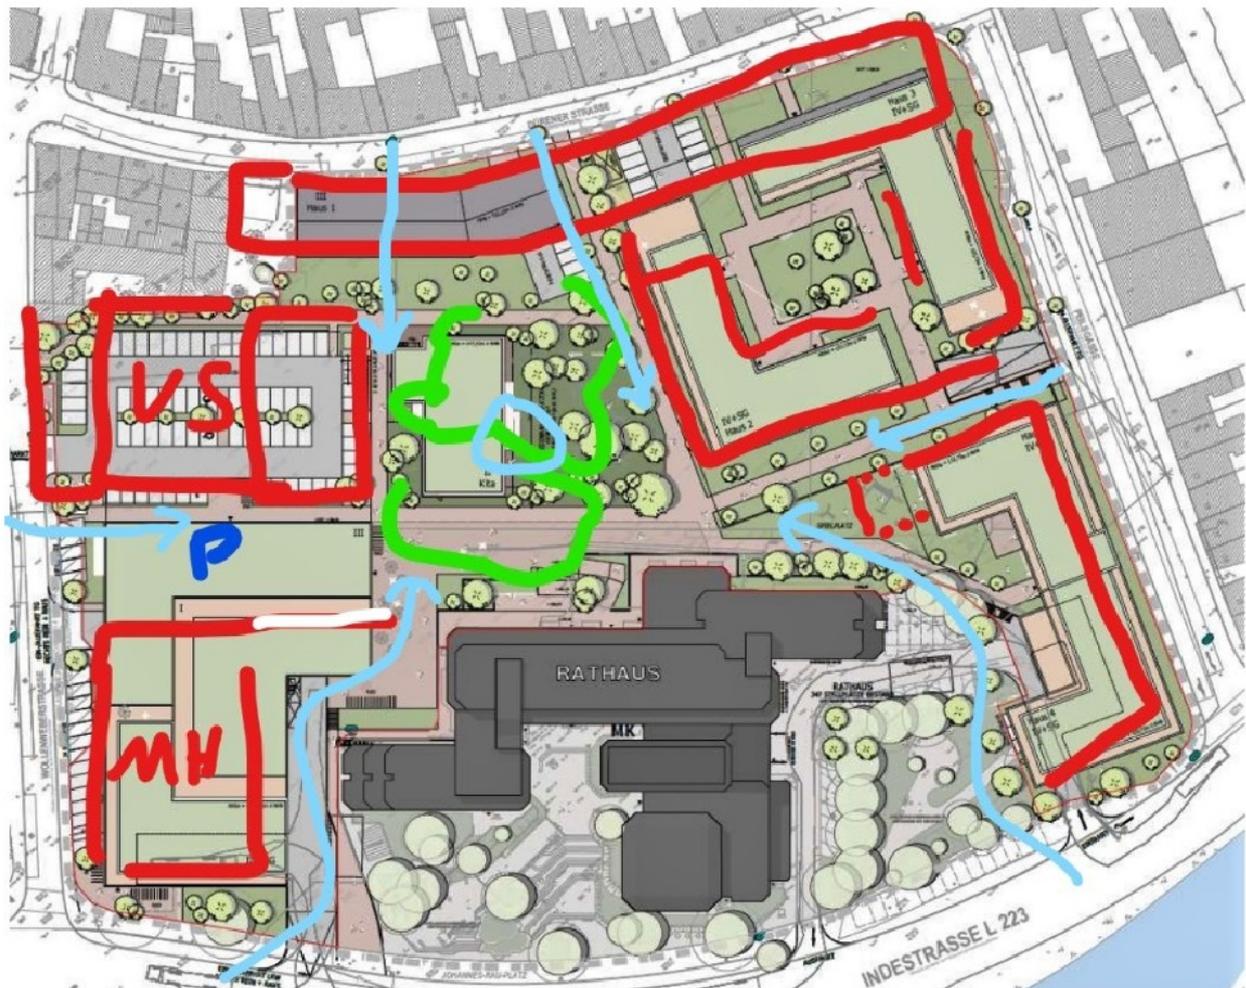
Lageplan des Projektes, Stand November 2022 [Quelle: Ten Brinke Gruppe], ohne Maßstab
